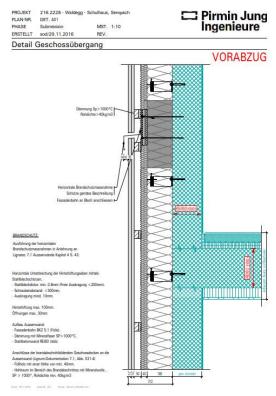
Musterdetail einer Holzfassade -Stand Erstellung Leistungsverzeichnis.
